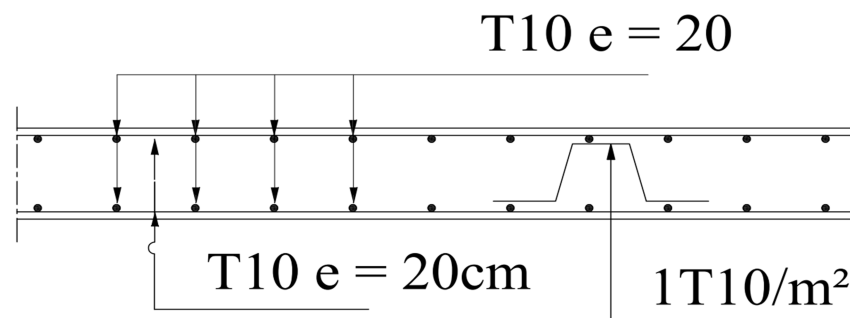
Schéma de ferrailage de la dalle machine d'ascenseur.
